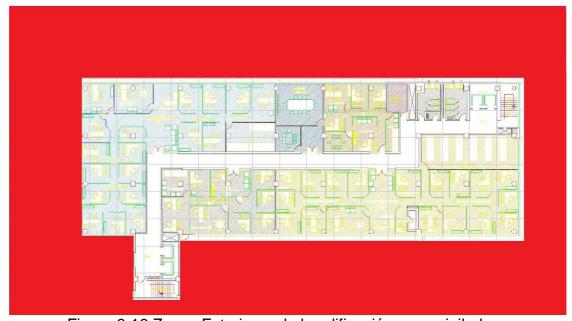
Zonas Exteriores de la edificación a ser vigiladas
